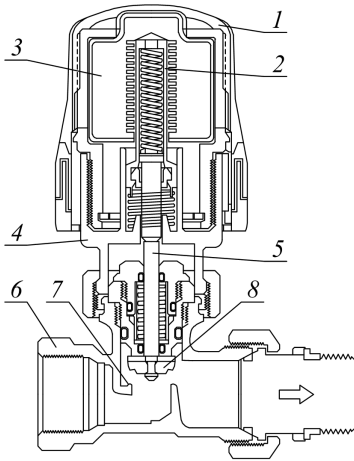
Схема радиаторного терморегулятора: 1 – рукоятка для настройки температуры; 2 – возвратная пружина; 3 – сифон; 4 – корпус термоголовки; 5 – нажимной шток; 6 – корпус вентиля; 7 – седло клапана; 8 – рабочий конус клапана
